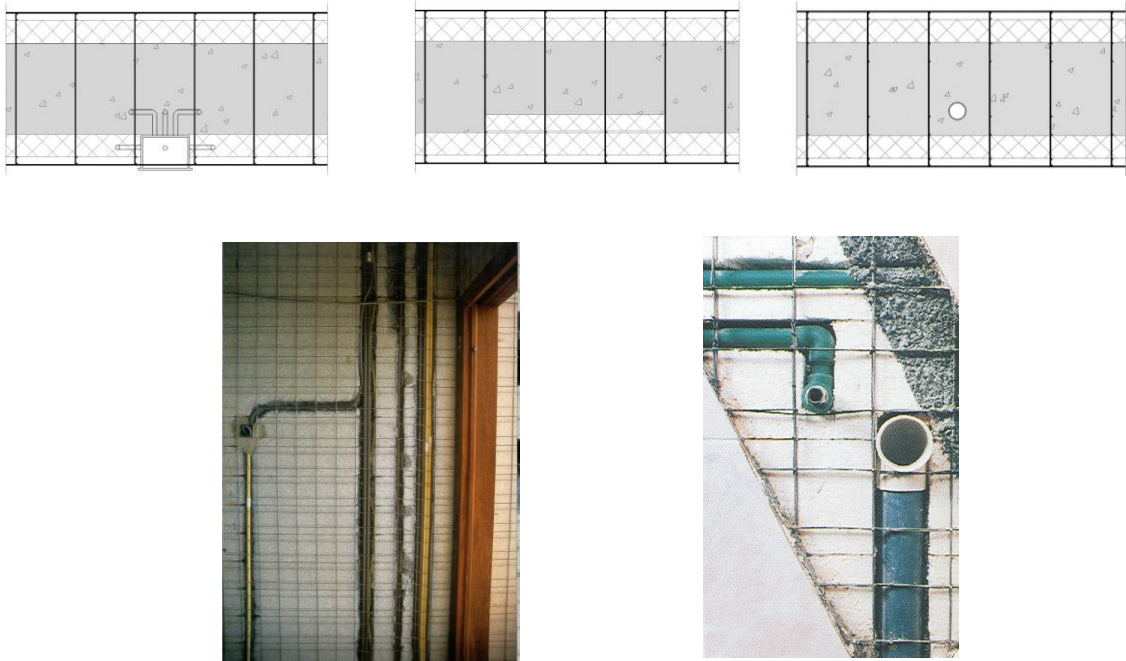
Conduits intégrés dans le béton et l'isolation, 1 avant le coulage du béton 2 dans l'isolation (couper ou faire fondre)
